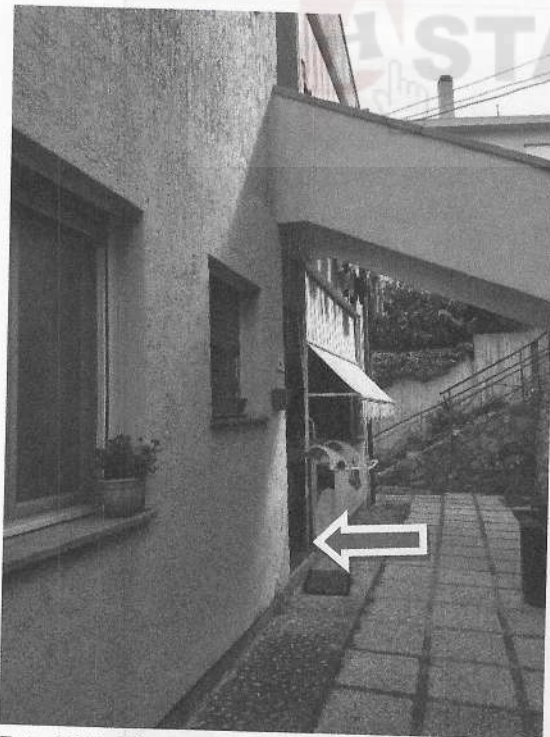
Vista della corte comune, antistante l'ingresso alla abitazione al Piano terra.
